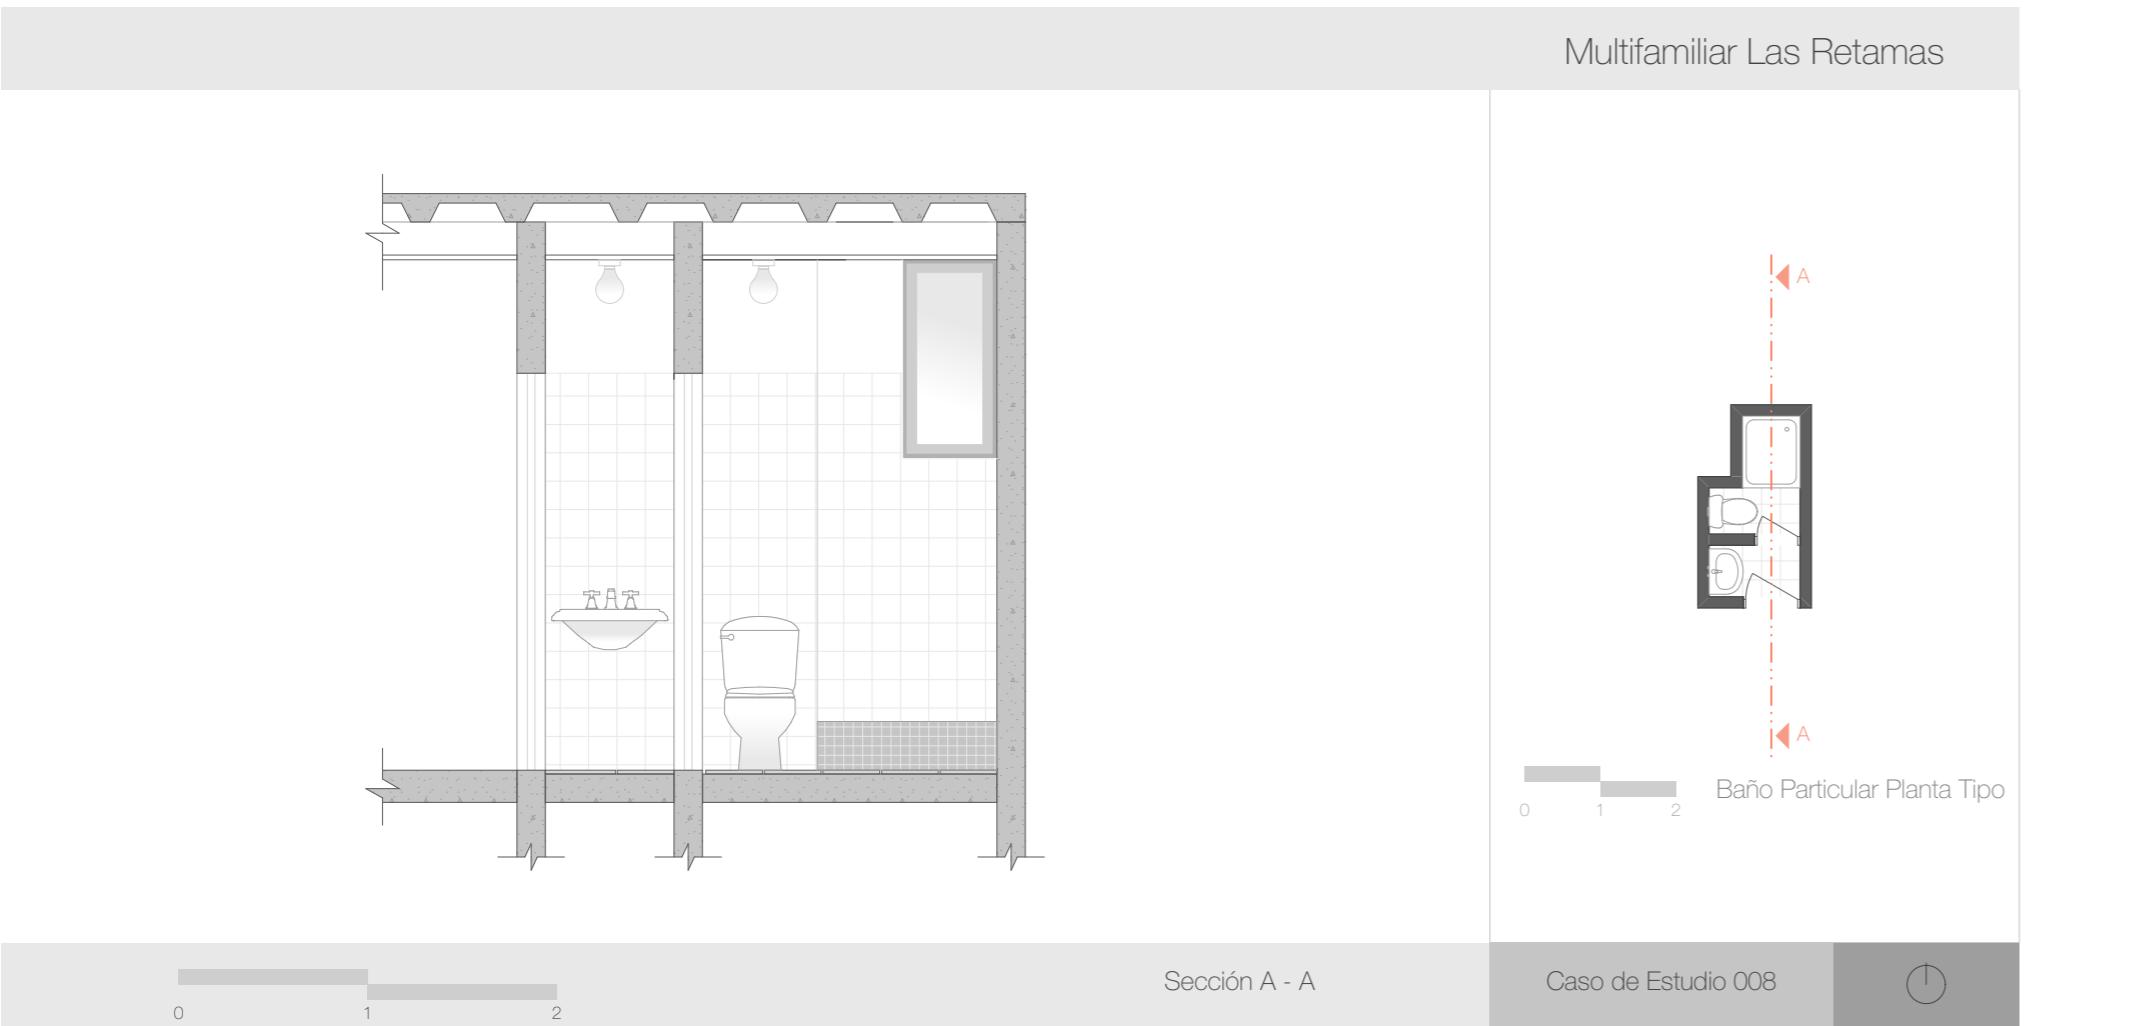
Multifamiliares Las Retamas Planta Tipo
